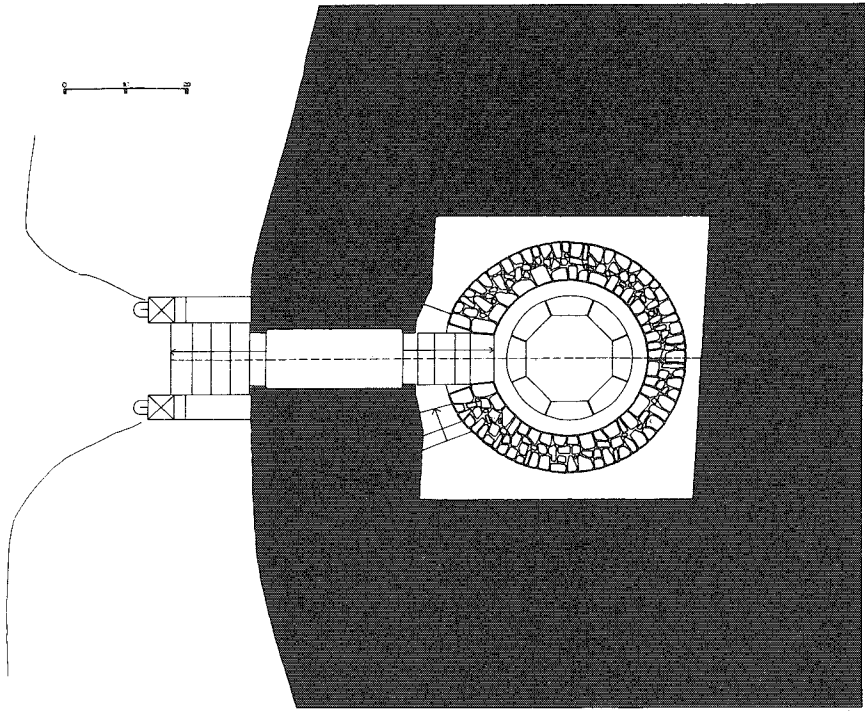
Coupe horizontale de l'ensemble de la glacière.
